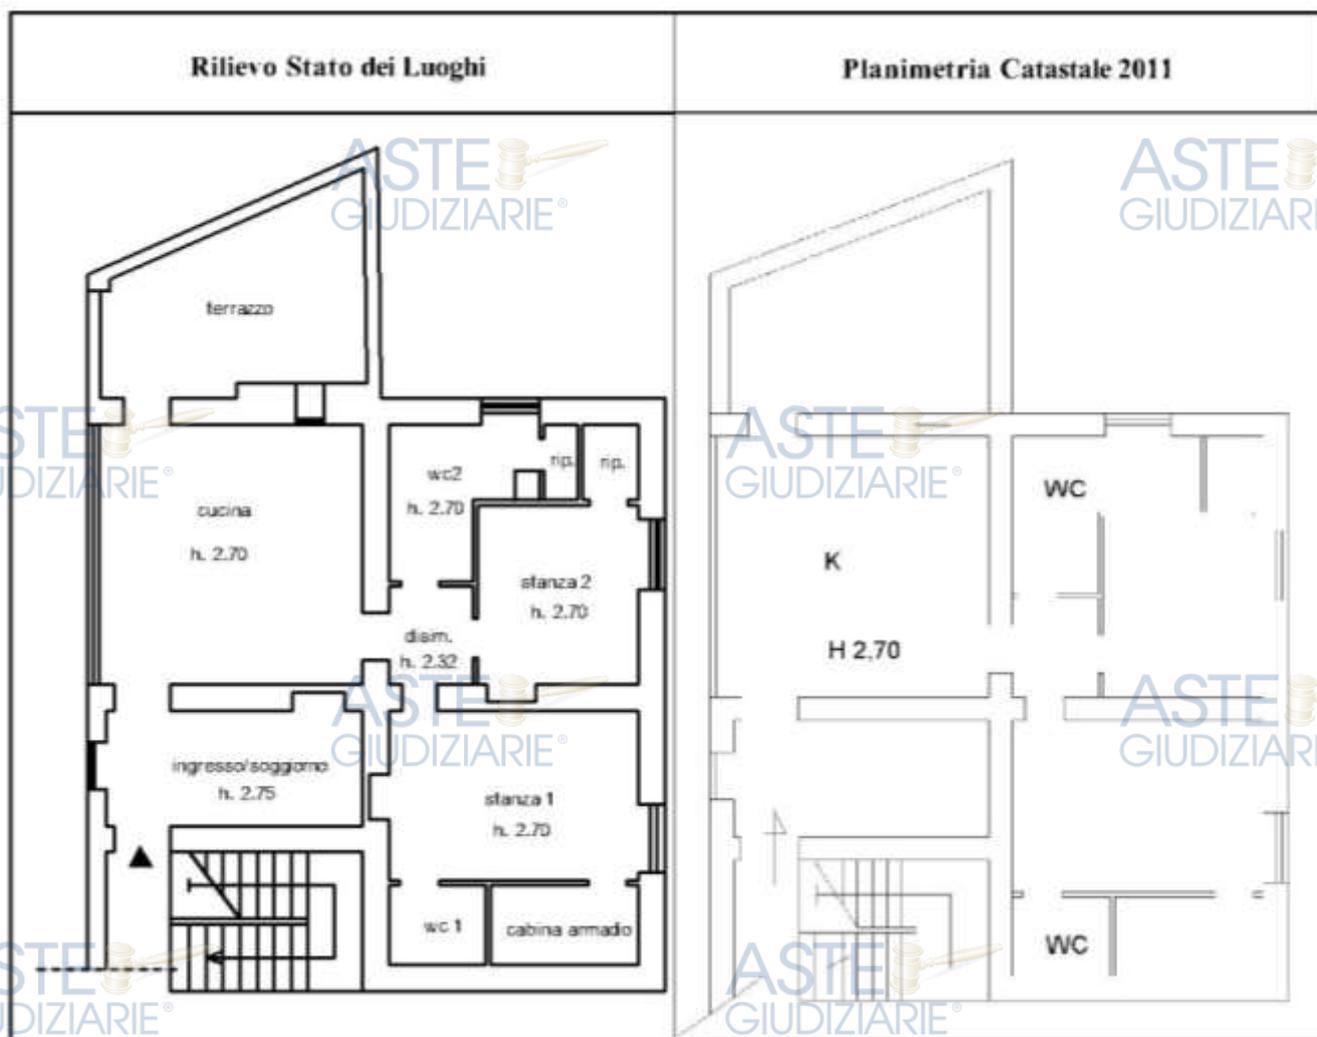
A destra la planimetria catastale attuale, a sinistra lo stato attuale dei luoghi
